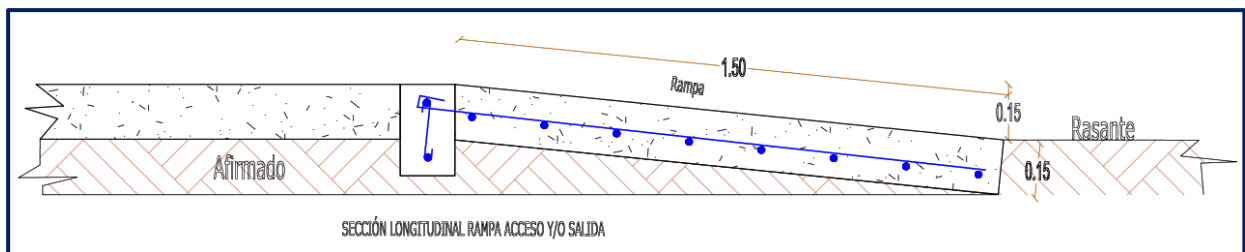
Vista de sección longitudinal Rampa acceso / Salida diseño placa huella de 4.5 m
